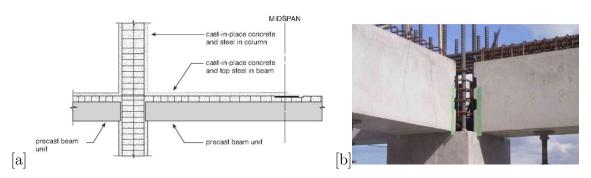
Conexión viga prefabricada entre columnas in-situ [a]. Fuente: (Aguirre, 2021); [b] Ejemplo real. Fuente: (Bedriñana, 2021)
